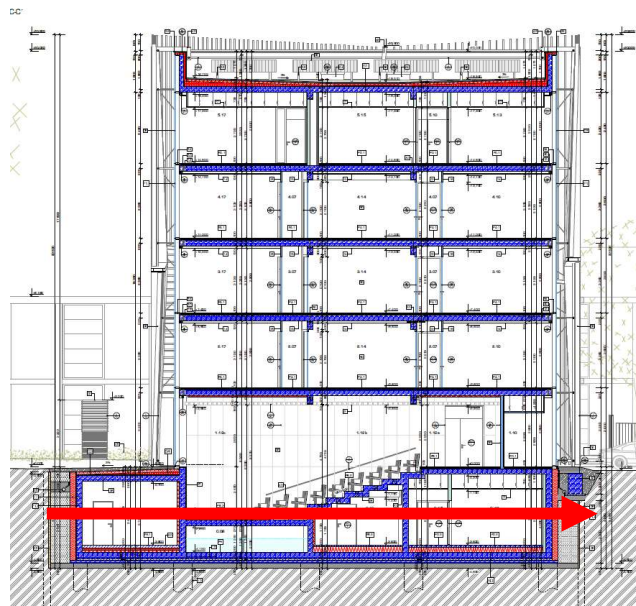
Směr postupu výstavby – TE 1 [1]
